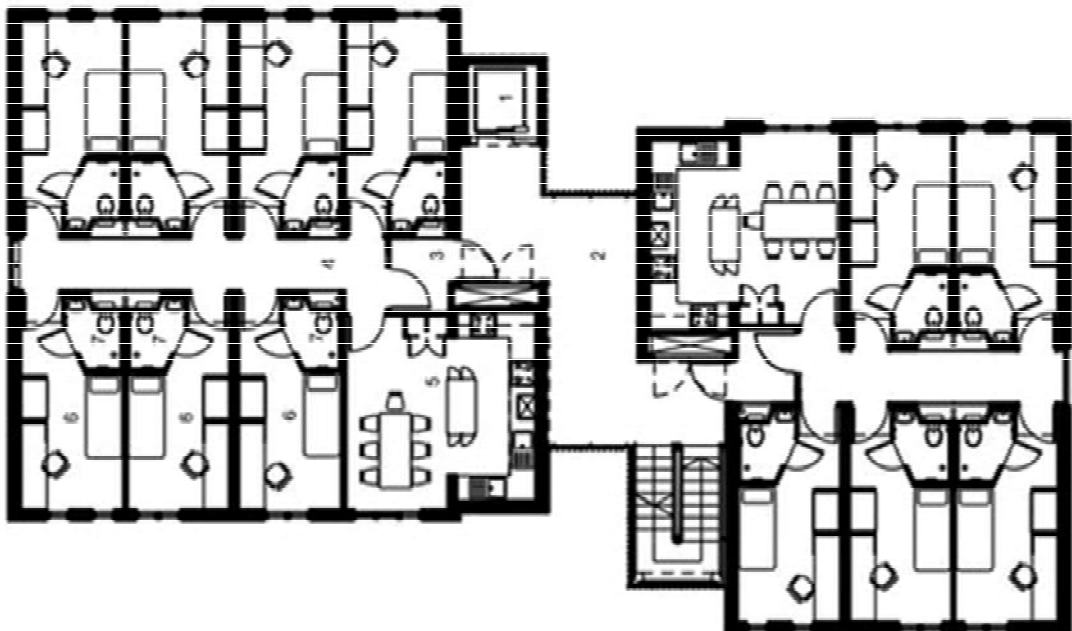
Planta do Pavimento Tipo. Alliance Student Housing, Newington Green, Reino Unido.
